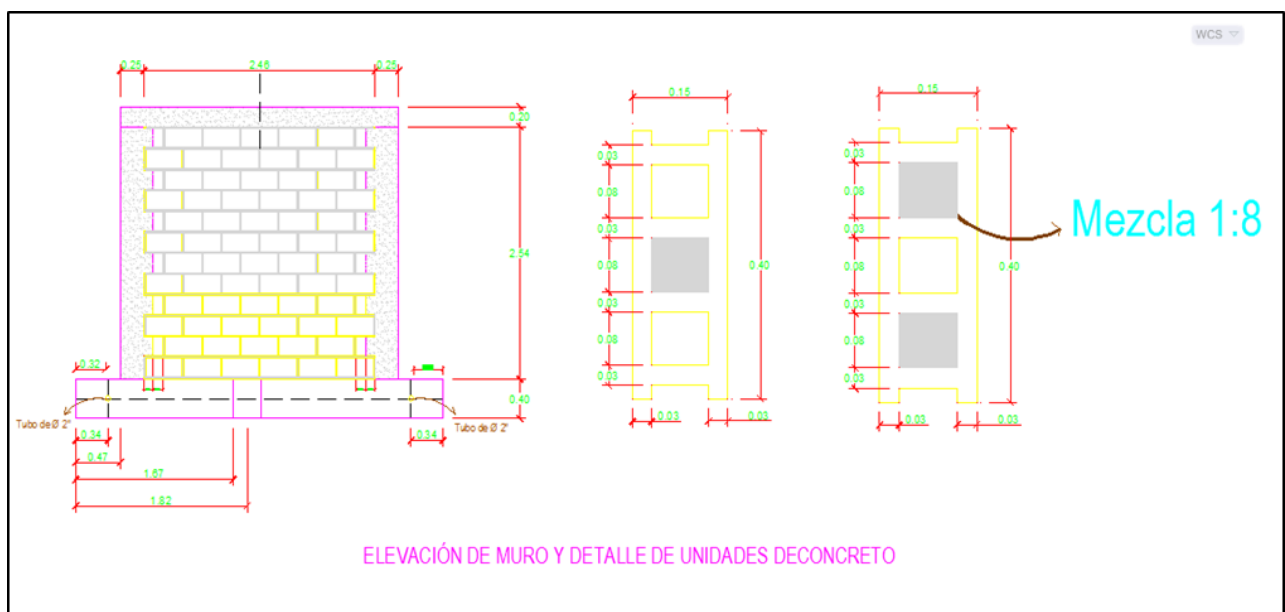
Elevación del muro de albañilería tipo Haití con bloque 33% y 66% alveolo relleno
